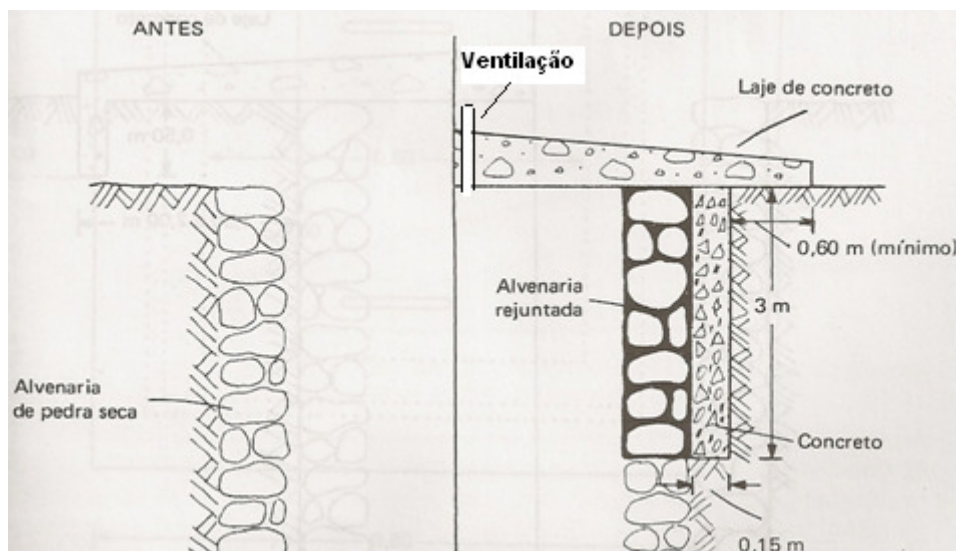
Melhoramento do poço, com impermeabilização das paredes nos três primeiros metros e construção de uma laje de cobertura de concreto.
